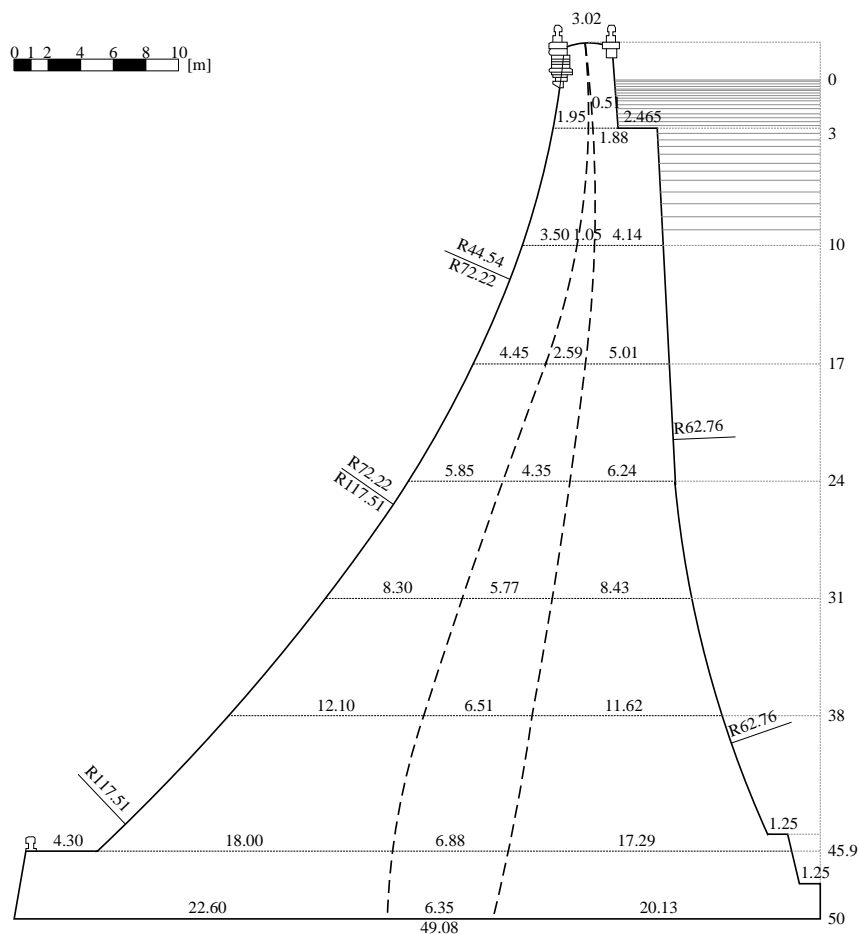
Perfil da barragem de Furens, perfil proposto por de Delocre, reprodução do original
